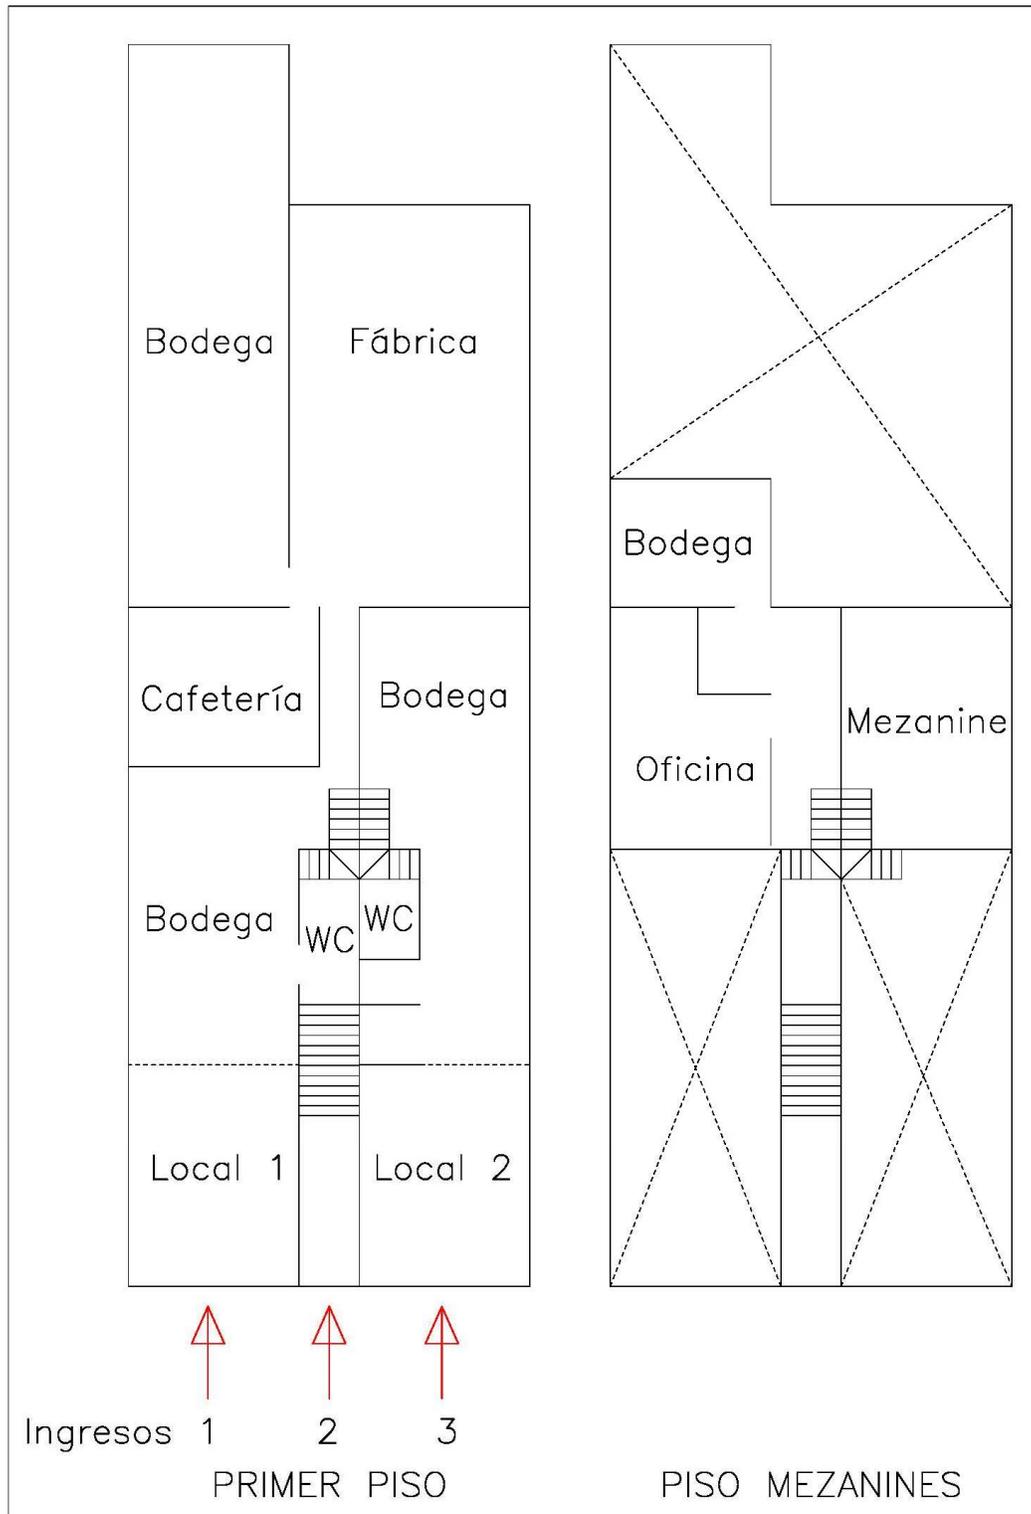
Croquis distribución arquitectónica locales comerciales primer piso y mezanines.
